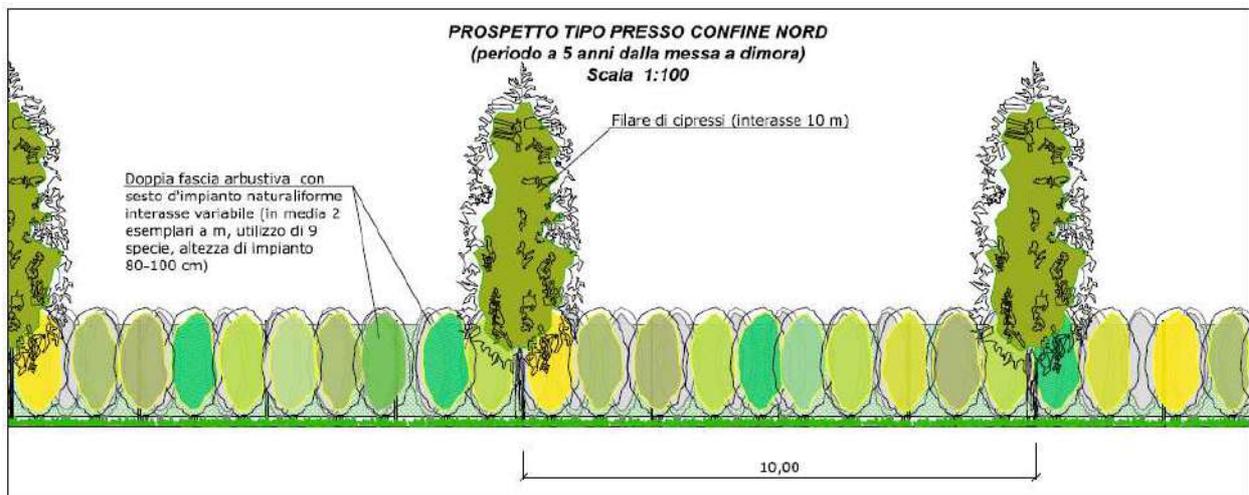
Prospetto tipo fascia di mitigazione perimetrale sul confine nord
